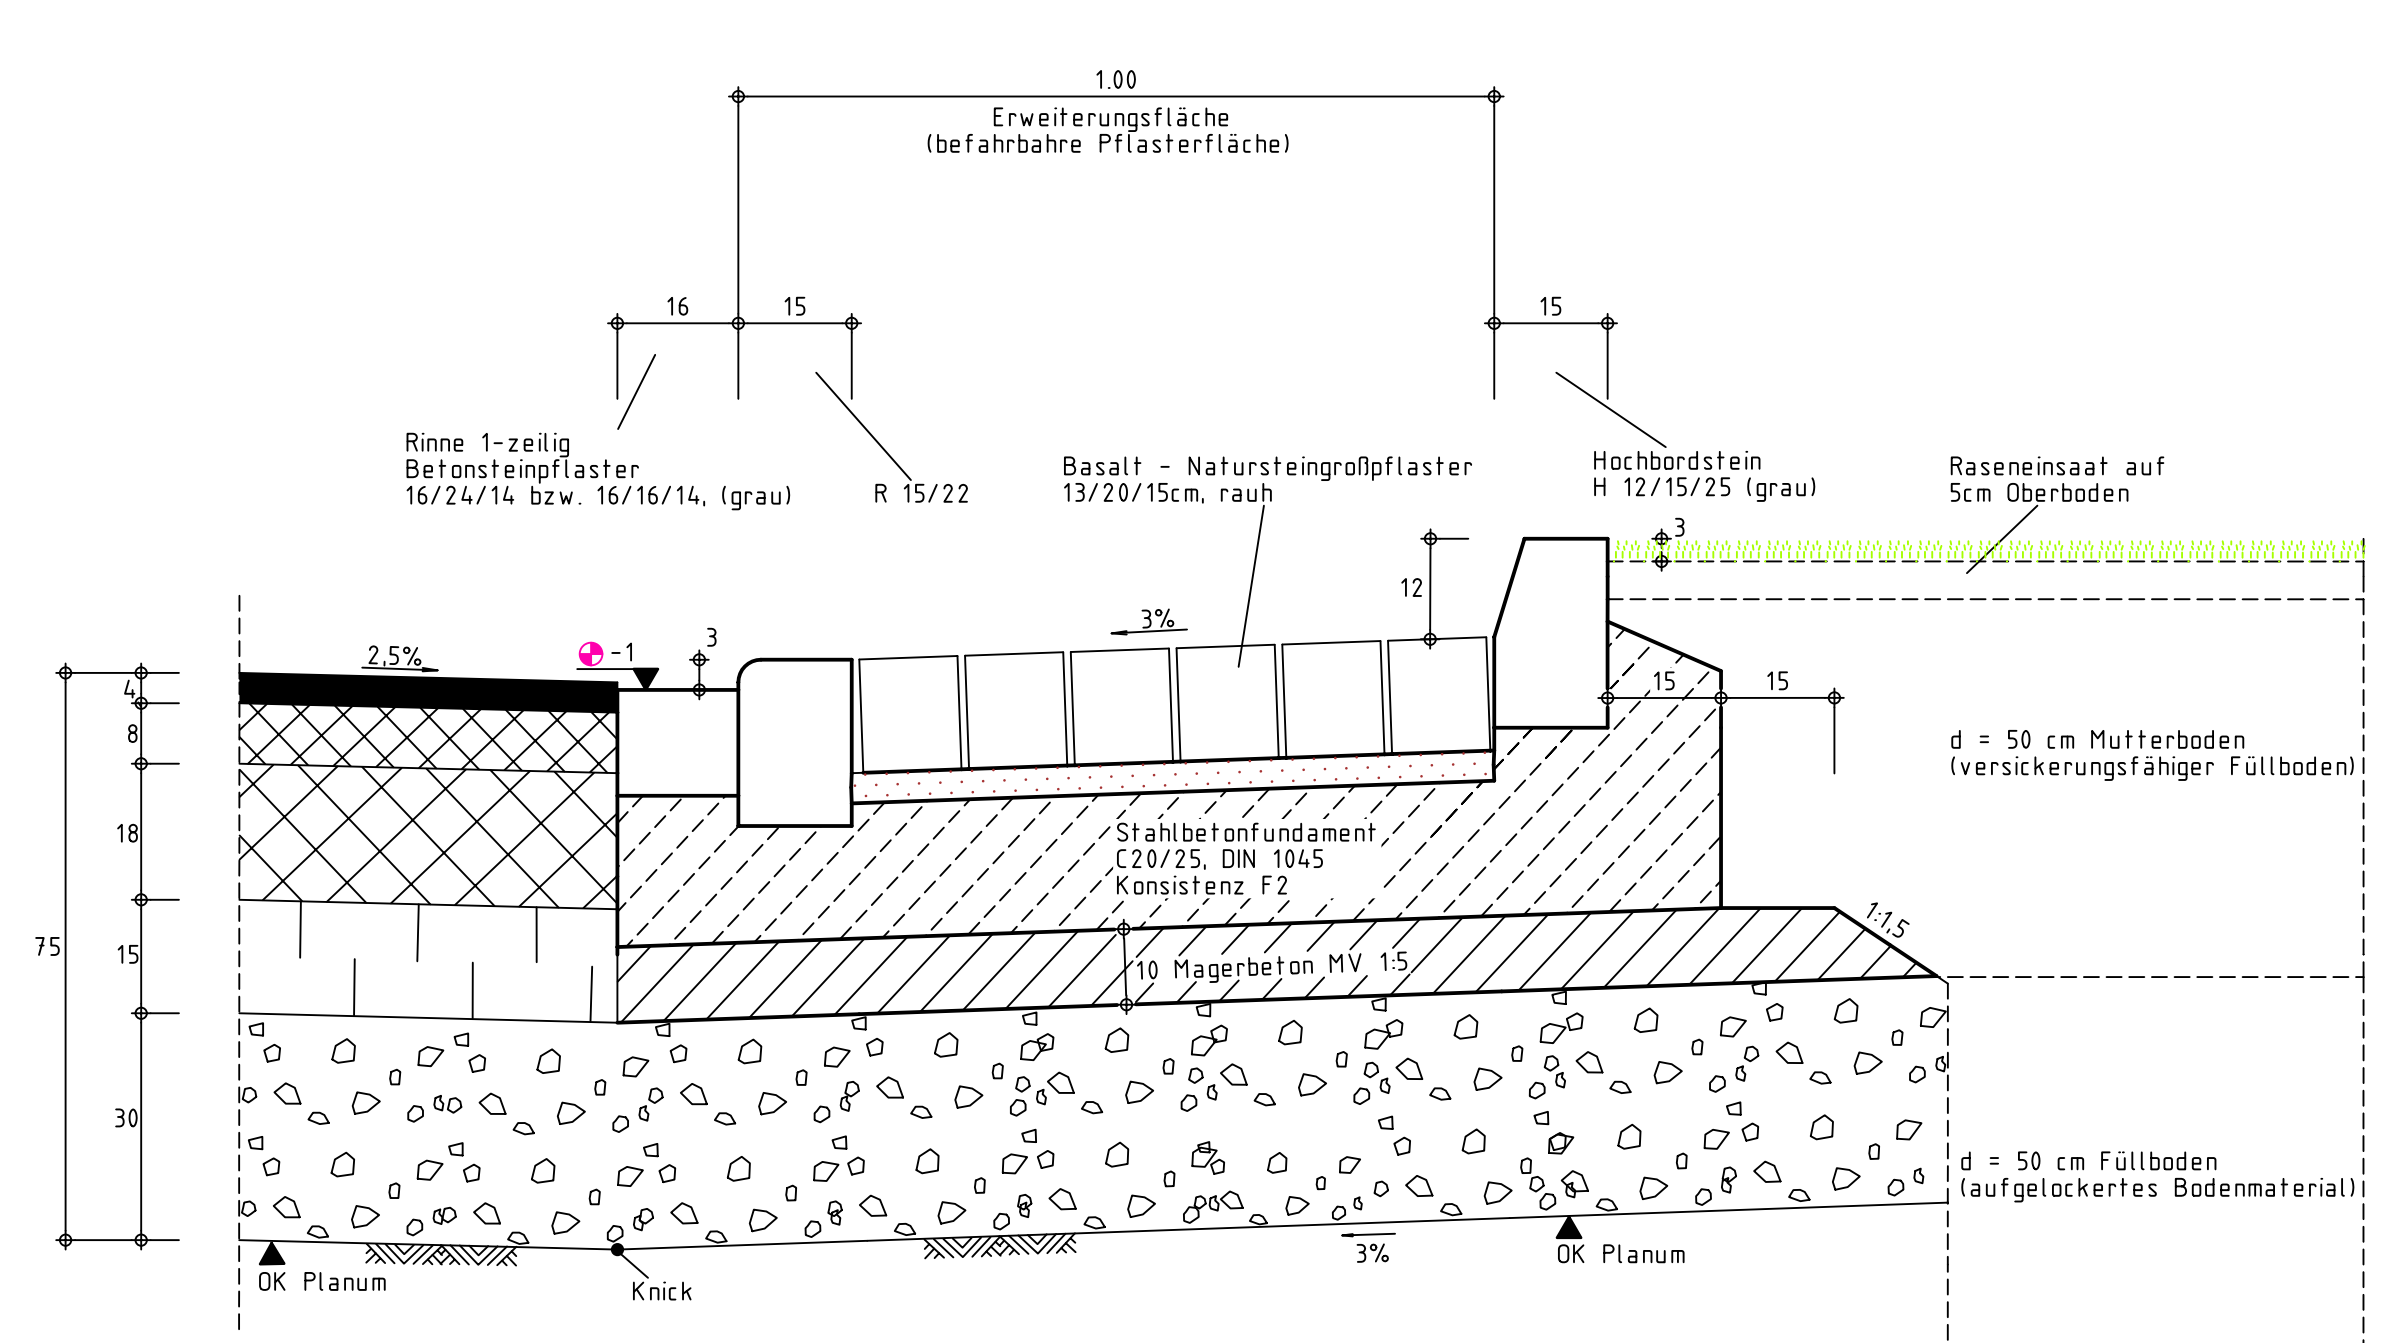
" Kreisinnening (Deckenaufbau auf der Bauwerksdecke aus Beton)
